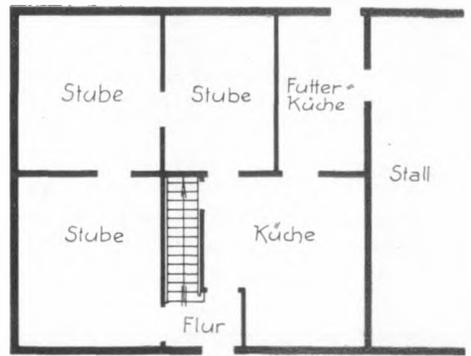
Angebautes Wohnhaus mit 4 Wohnräumen und Futterküche im Erdgeschoß. Ausbau von 1—2 Giebelzimmern im Dachgeschoß ist möglich, Erweiterung durch Anbau ist nicht möglich.
